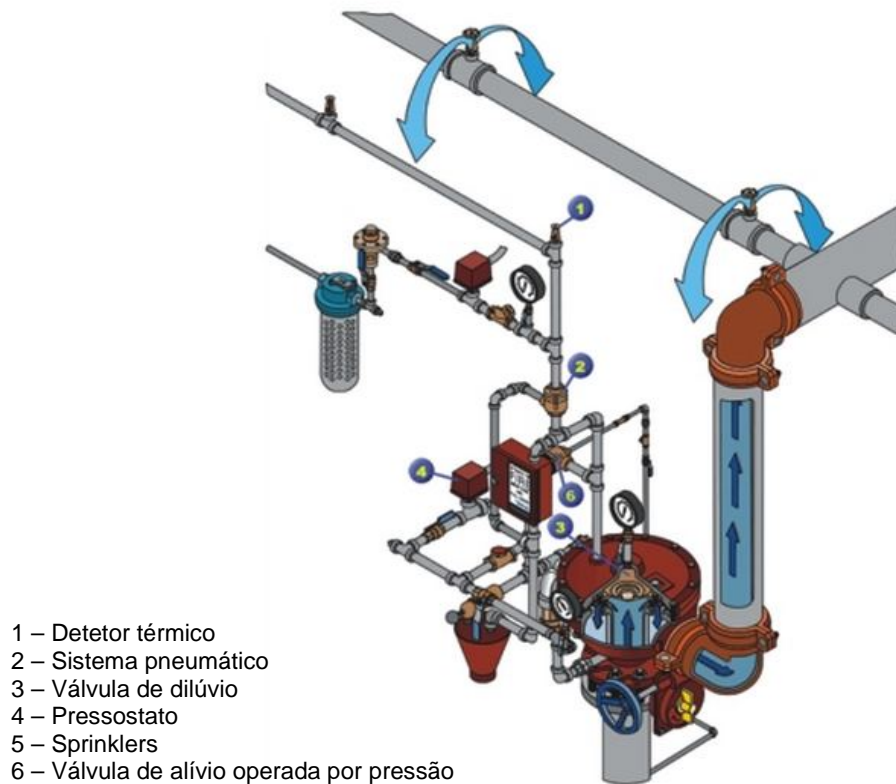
Instalação de sprinklers de dilúvio (deluge) [13].
